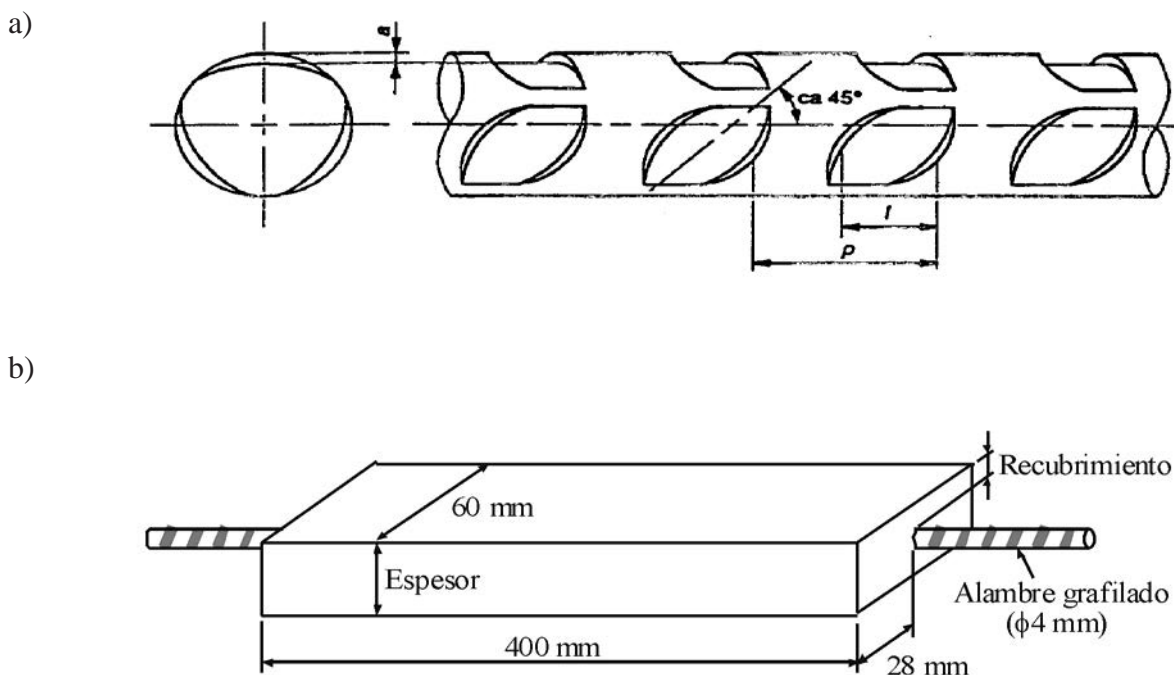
a) Geometría de la grafila; b) geometría y dimensiones de las probetas de hormigón pretensado con un alambre grafilado embebido.
